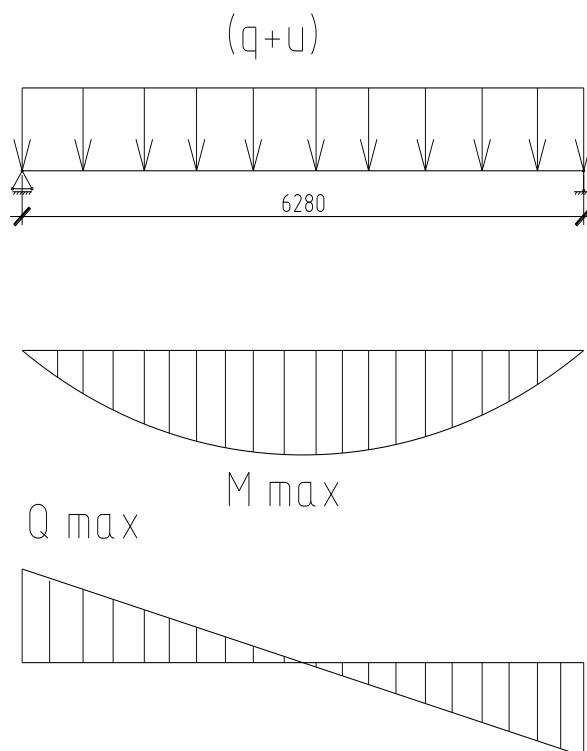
Расчетная схема плиты и эпюры усилий
